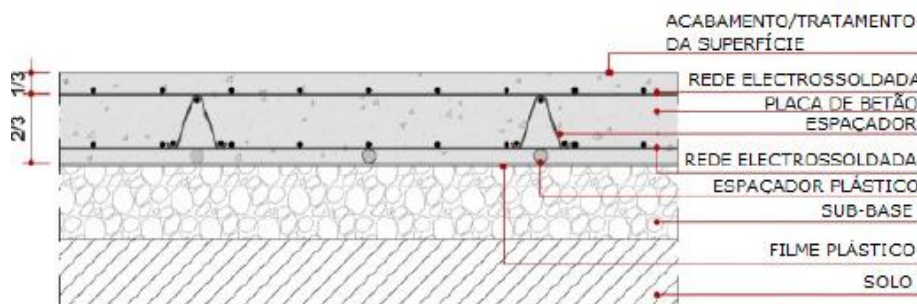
Pavimento com reforço estrutural (Passos, 2011)
